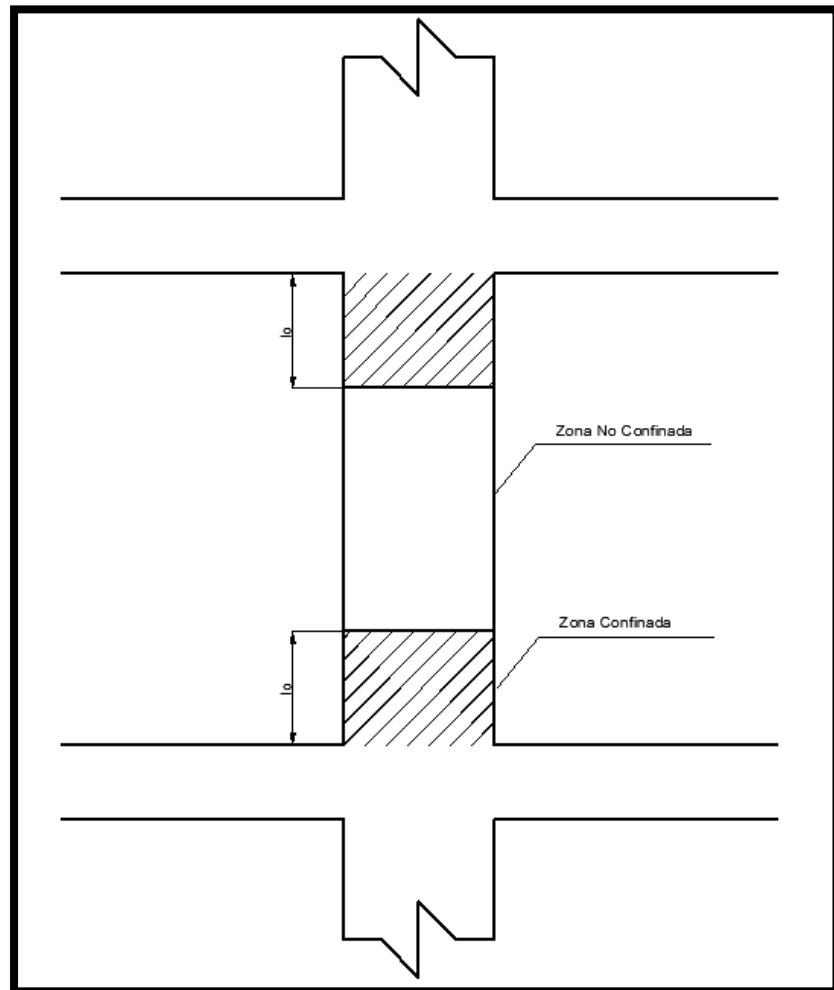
Longitud de Zona de Confinamiento en Columnas
